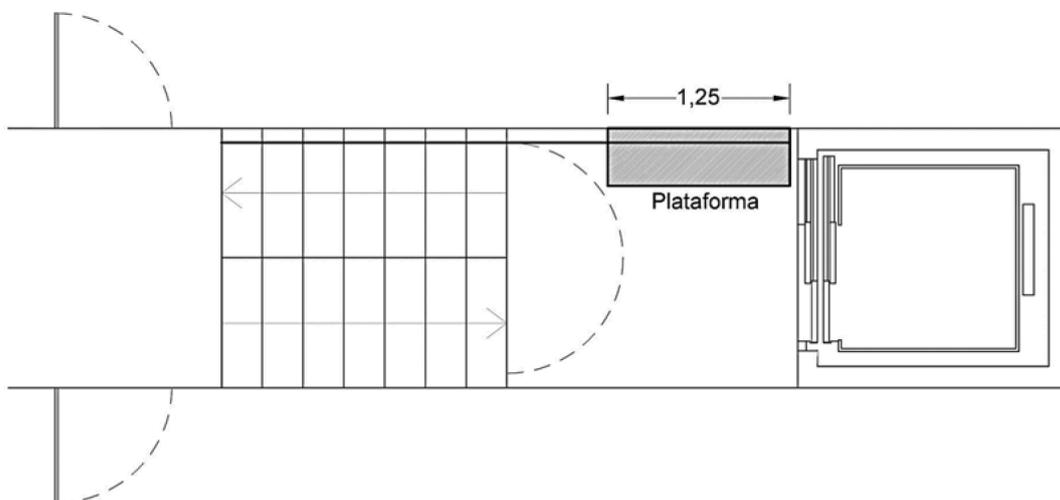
9. Plataforma elevadora inclinada plegada en posición de descanso en el rellano intermedio
